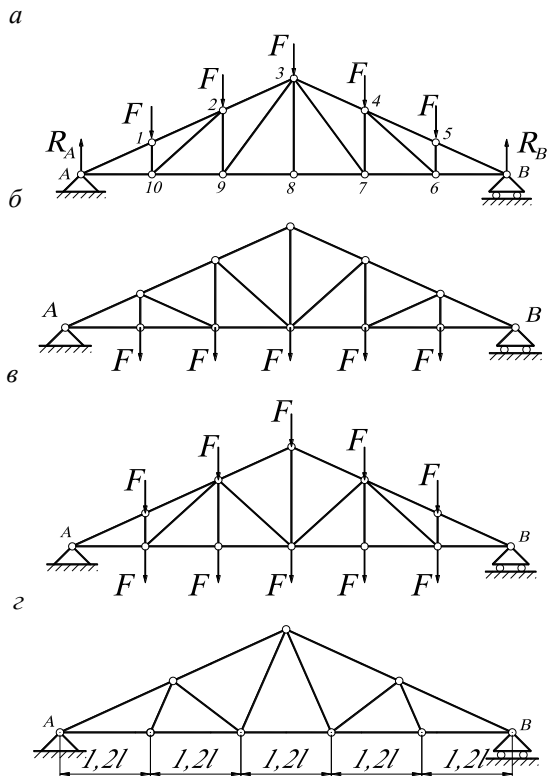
Фермы треугольного очертания с различным вариантом приложения нагрузки: а – к узлам верхнего пояса; б – к узлам нижнего пояса; в – к узлам верхнего и нижнего пояса; г – ферма без стоек.
